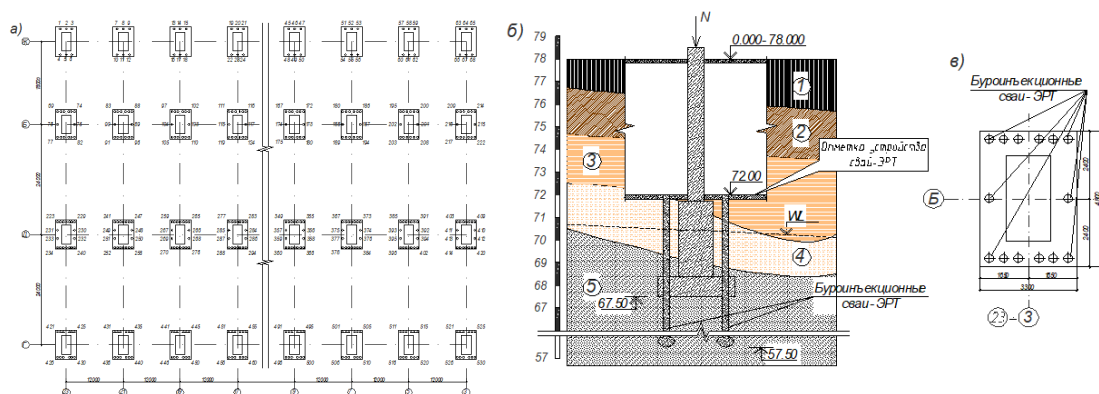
а – План расположения буринъекционных свай-ЭРТ; б – Сечение фундамента в осях Д/12 с привязкой в инженерно-геологический разрез; в – план буринъекционных свай-ЭРТ усиления основания в осях Б/5.
